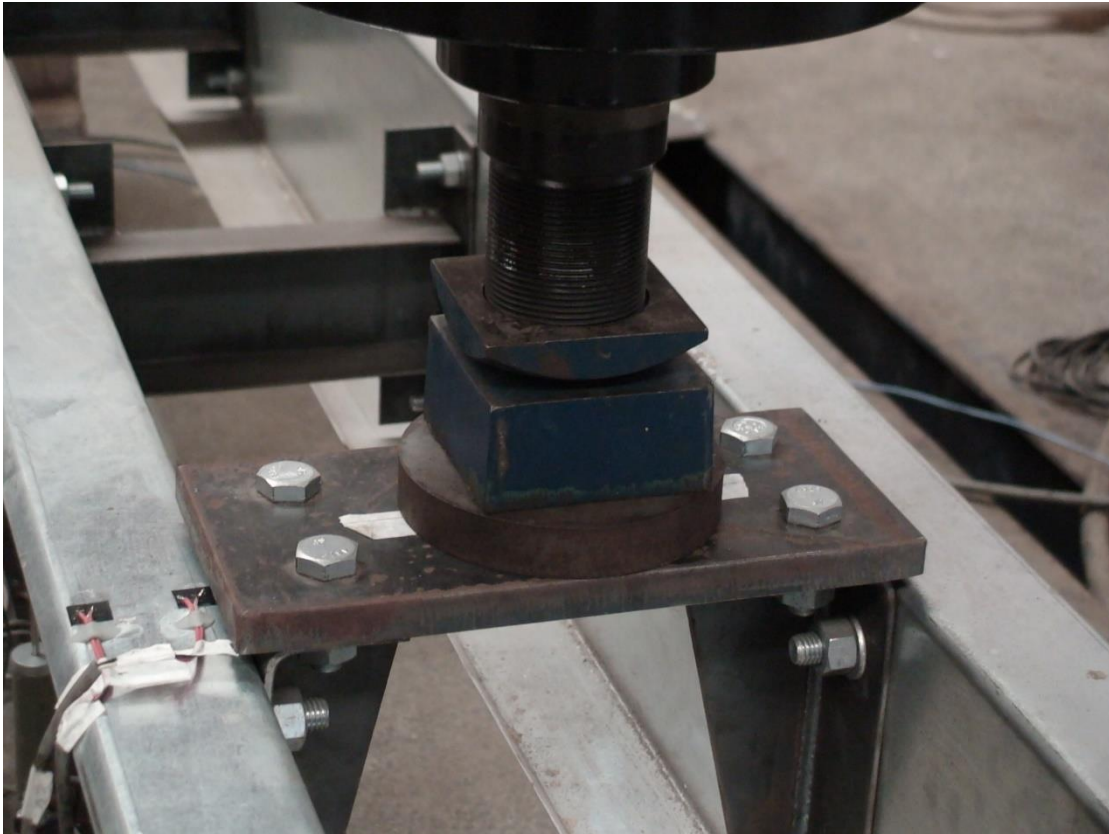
Detalhe do aparato de aplicação de força e da rótula sob o pistão.
